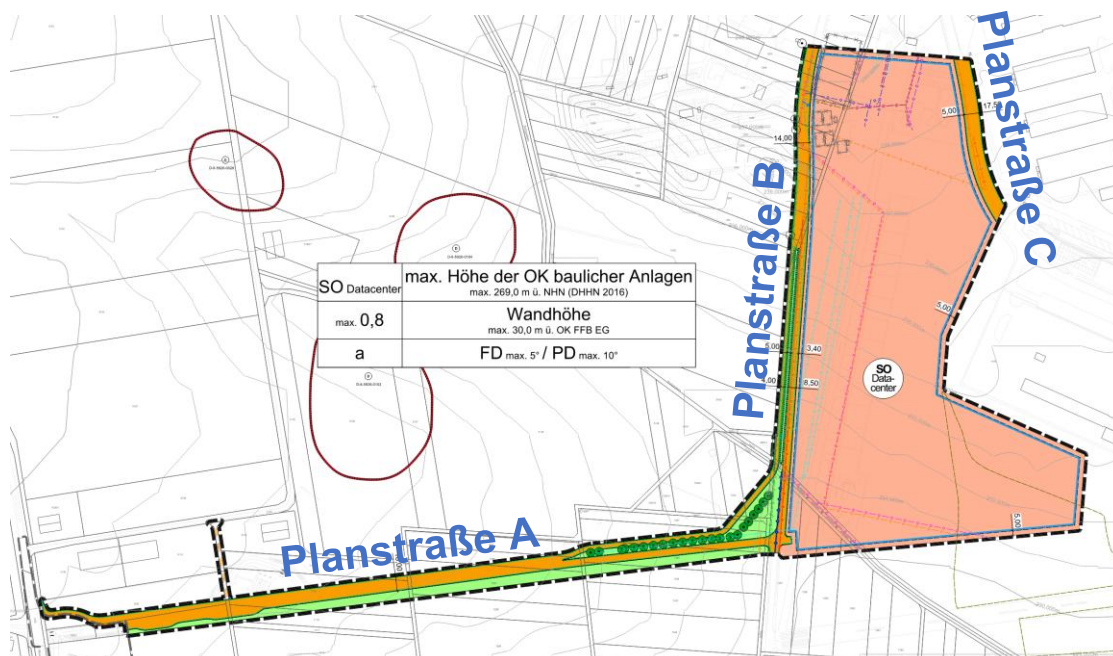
Auszug aus dem Planteil zum vorliegenden Bebauungsplan mit Beschriftung der nachfolgend beschriebenen Straßenquerschnitte (blau)
